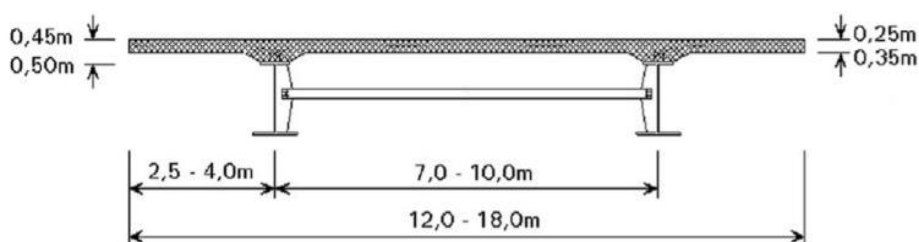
Secção transversal de um tabuleiro misto com vigas de alma cheia [W1]
